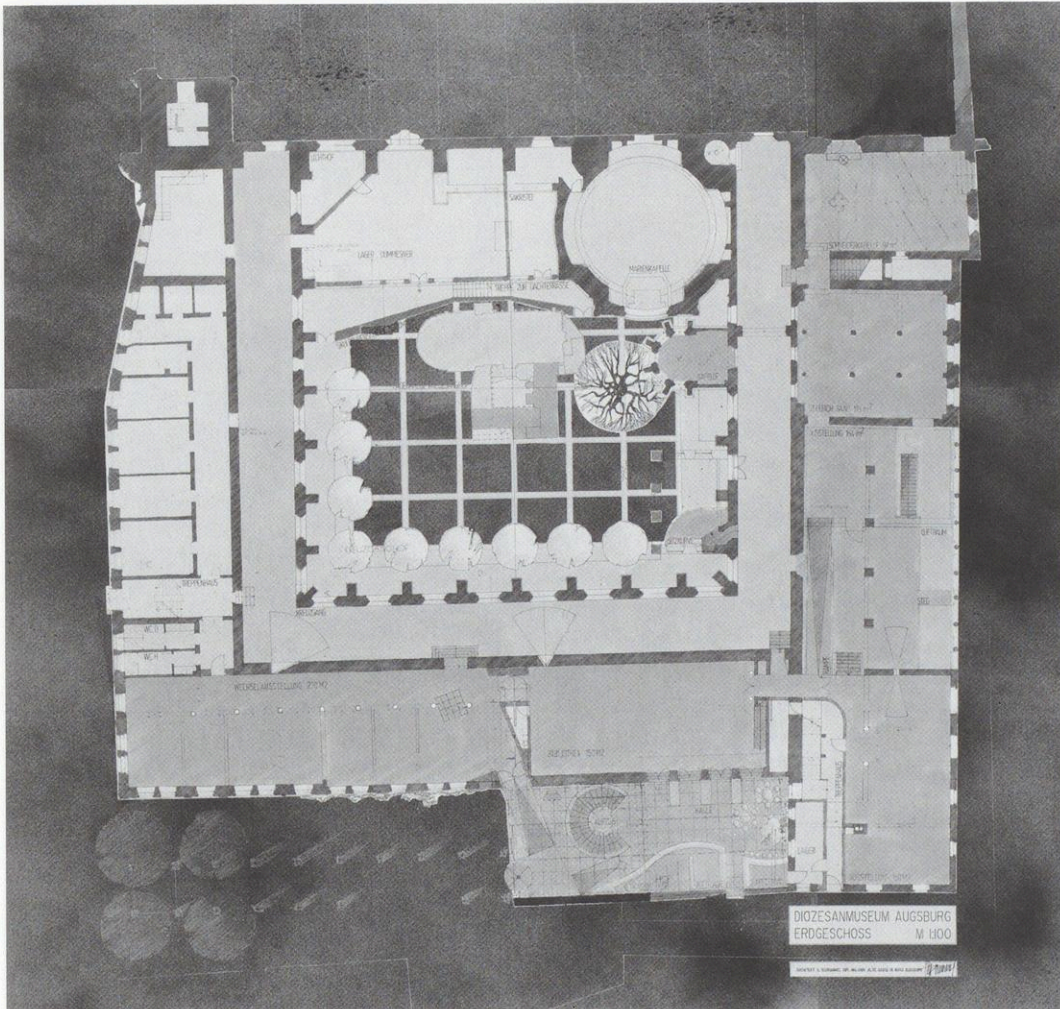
Grundriß Erdgeschoß, Vorentwurf 1989
